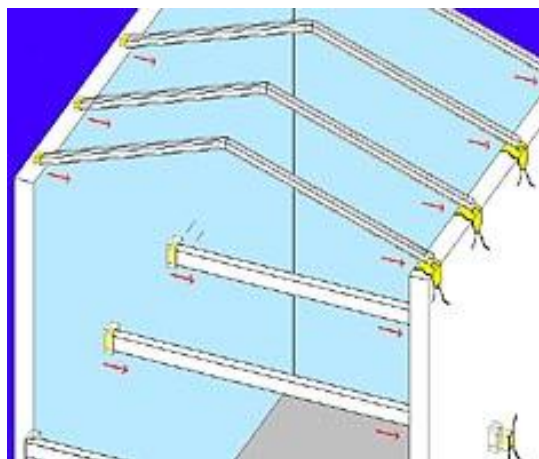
Sfilamento delle travi del solaio dalla parete di supporto
